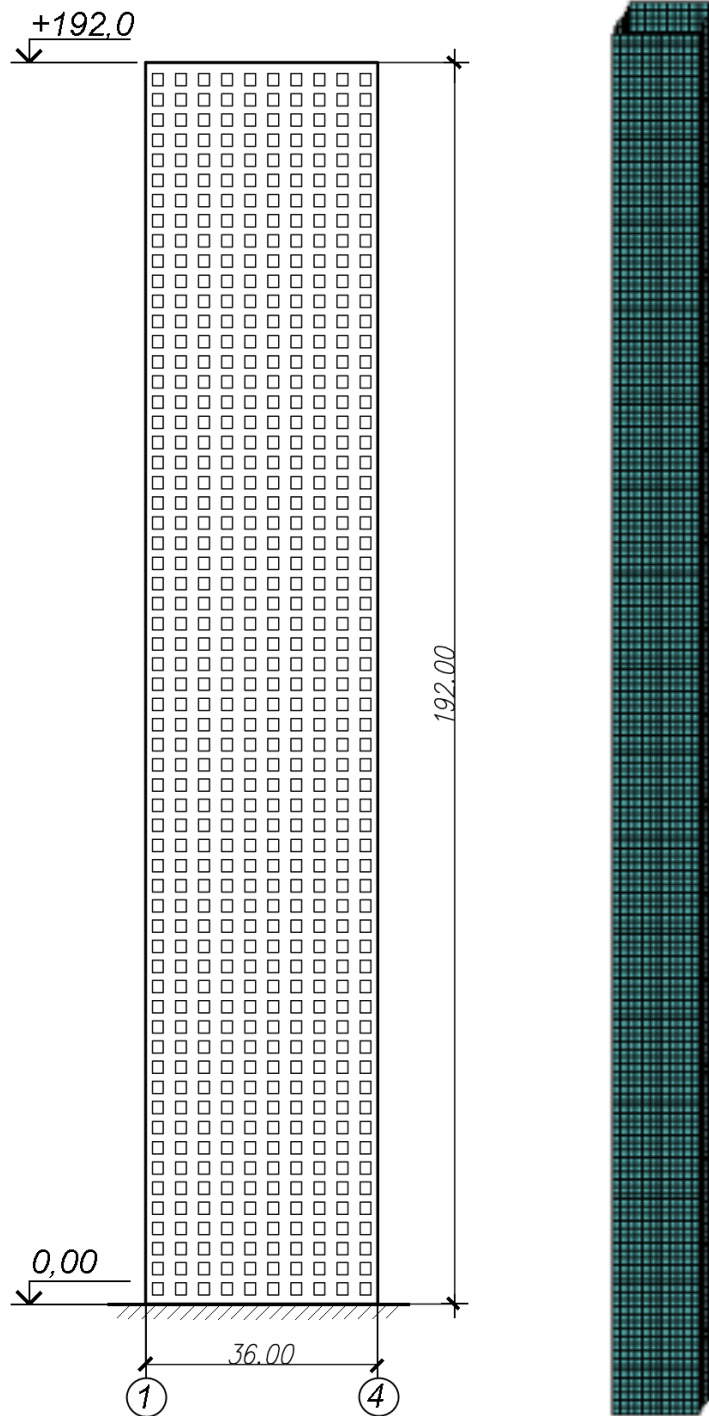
Фасад будівлі і кінцево-елементна модель будівлі
